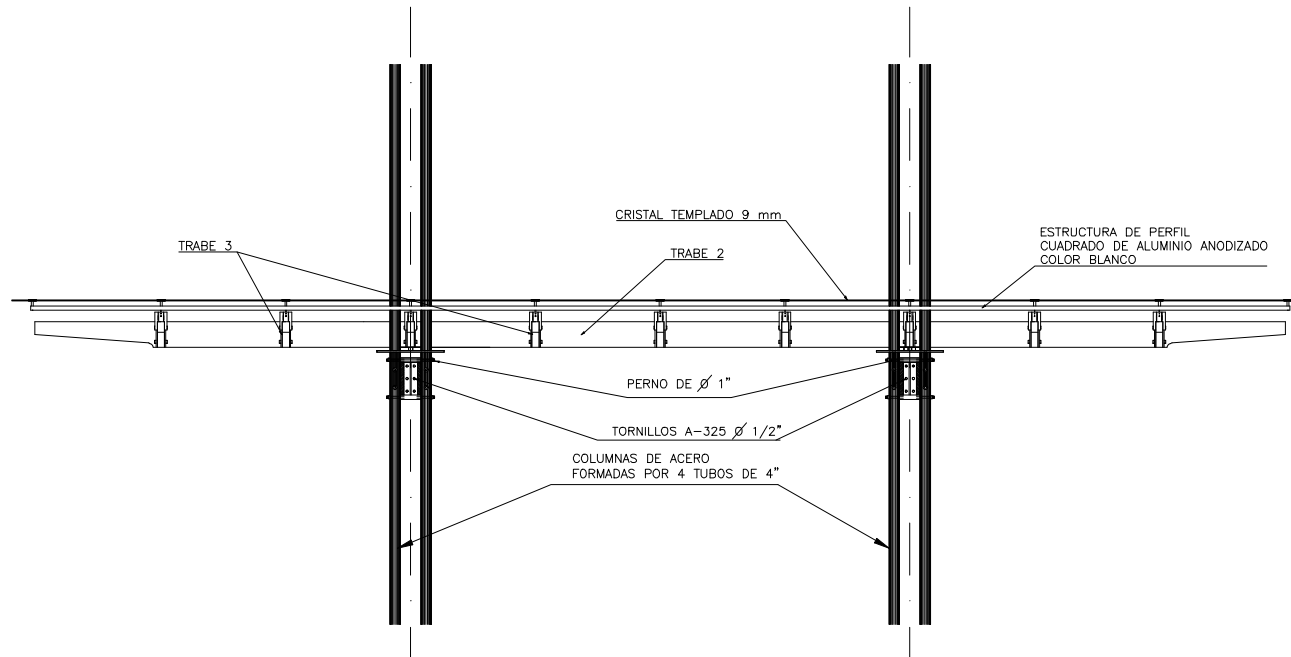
SISTEMA CONSTRUCTIVO PARA CUBIERTAS EN PATIOS INTERIORES
